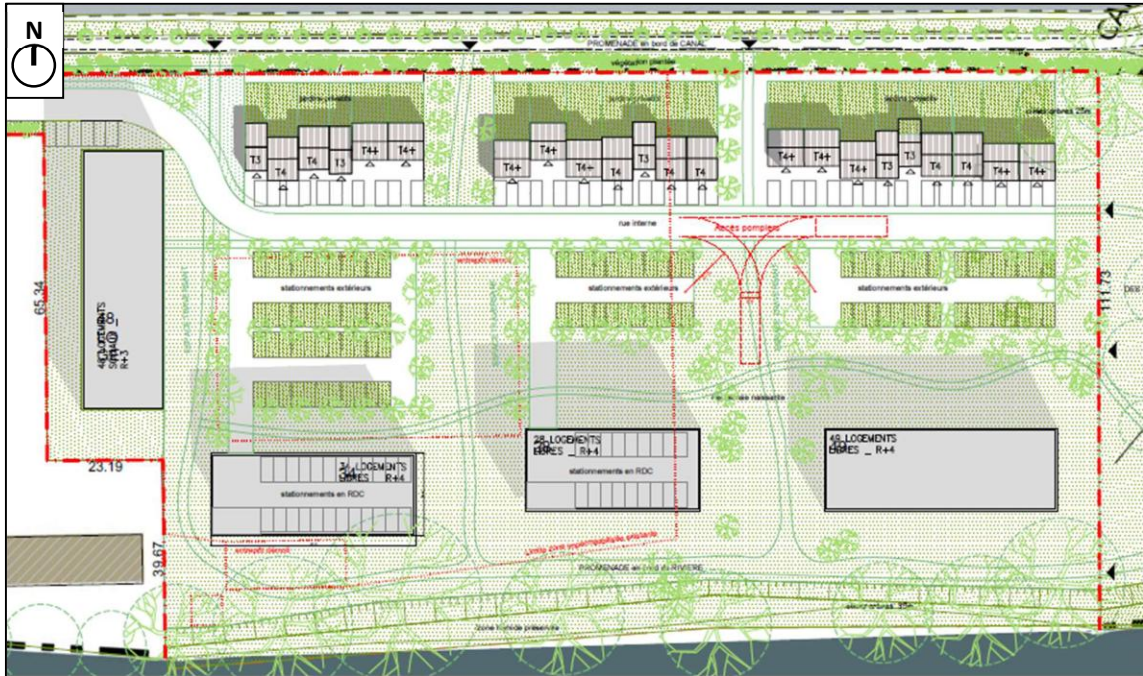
Extrait du plan de masse du projet (Source : Schurdi-Levraud Architecture)
